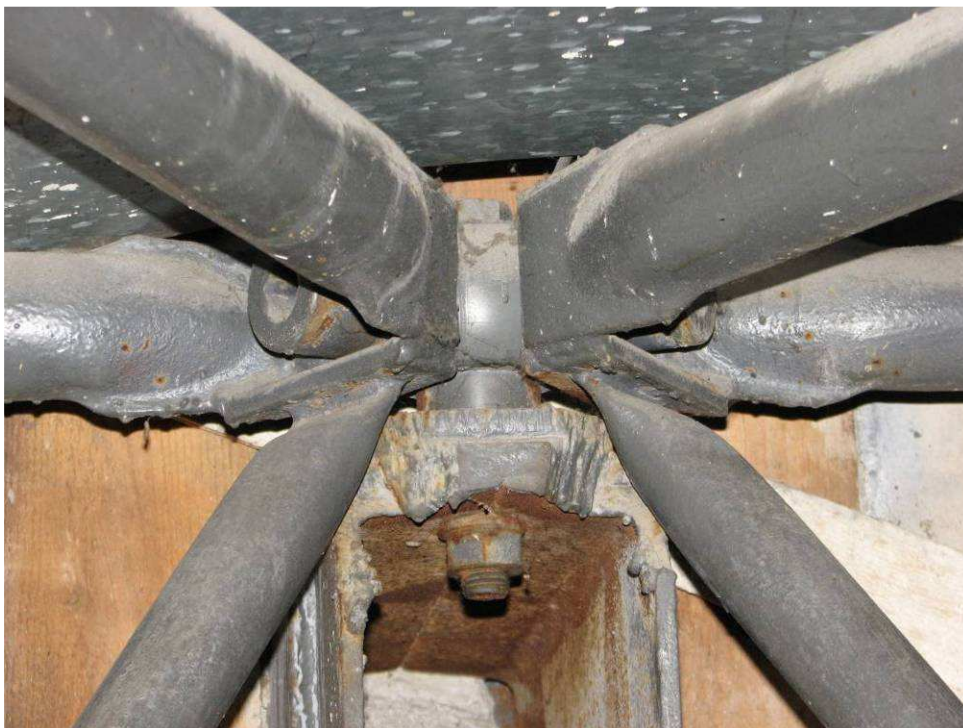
Pohled na styčník – uložení prutů horní roviny na konzoly. Nezačištěný povrch prvků, lokální koroze (typický stav).
